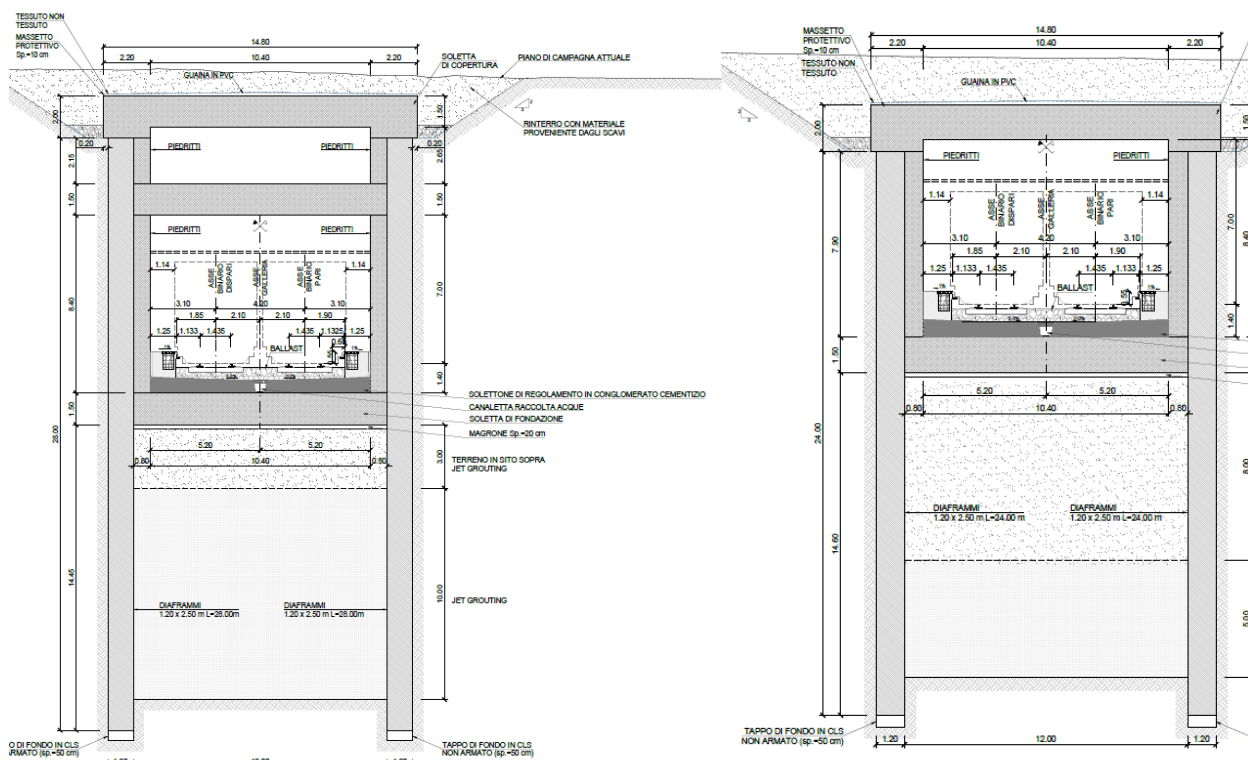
Sezione tipo GA01: sezione centrale a SX e sezione laterale a DX
